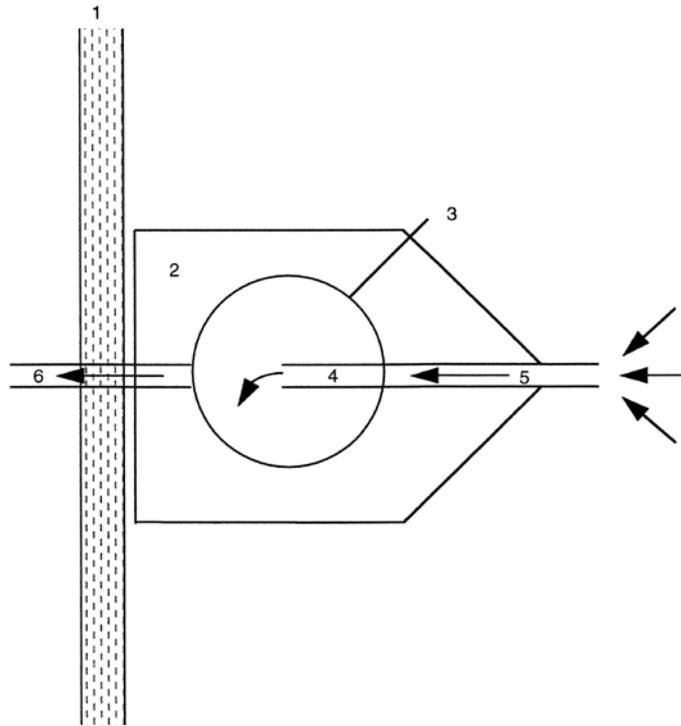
Beispiel eines Regulierschachtes; Grundriss
